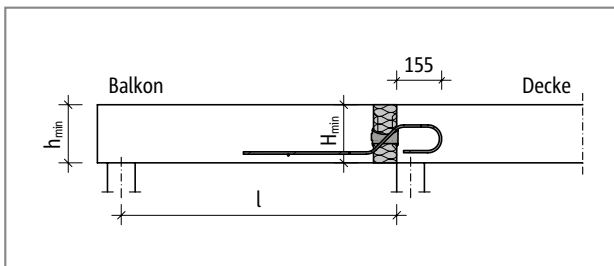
Schöck Isokorb® Typ Q10S bis Q30S: Statisches System
